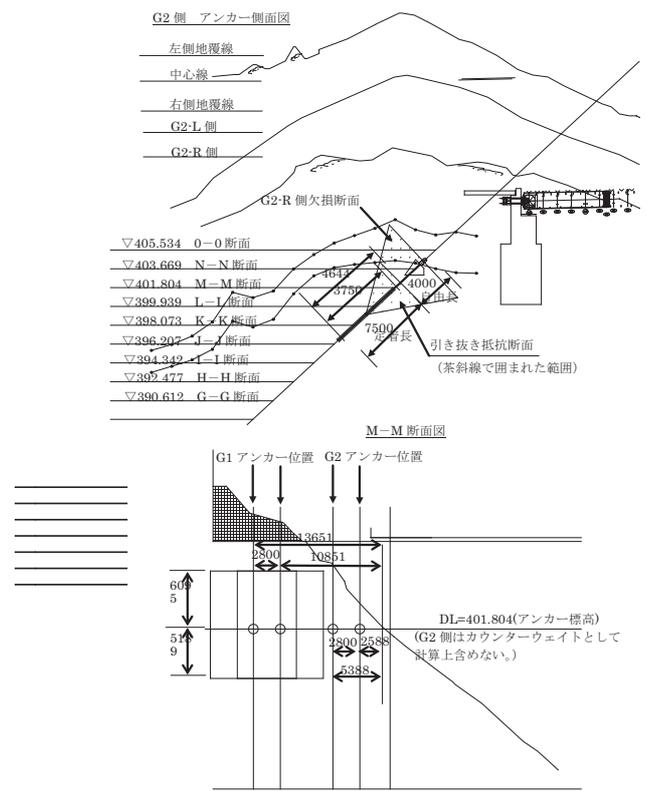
測量結果を用いたアンカー計画図 (上：側面図 下：断面図)
